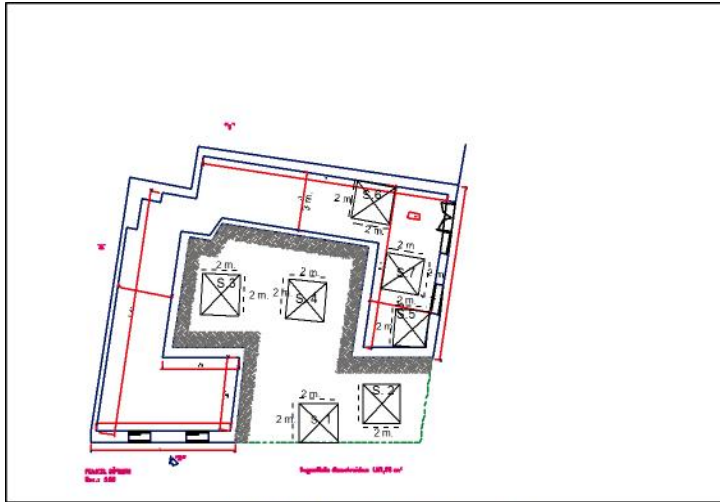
Planteamiento de los sectores de excavación. E. 1:150
